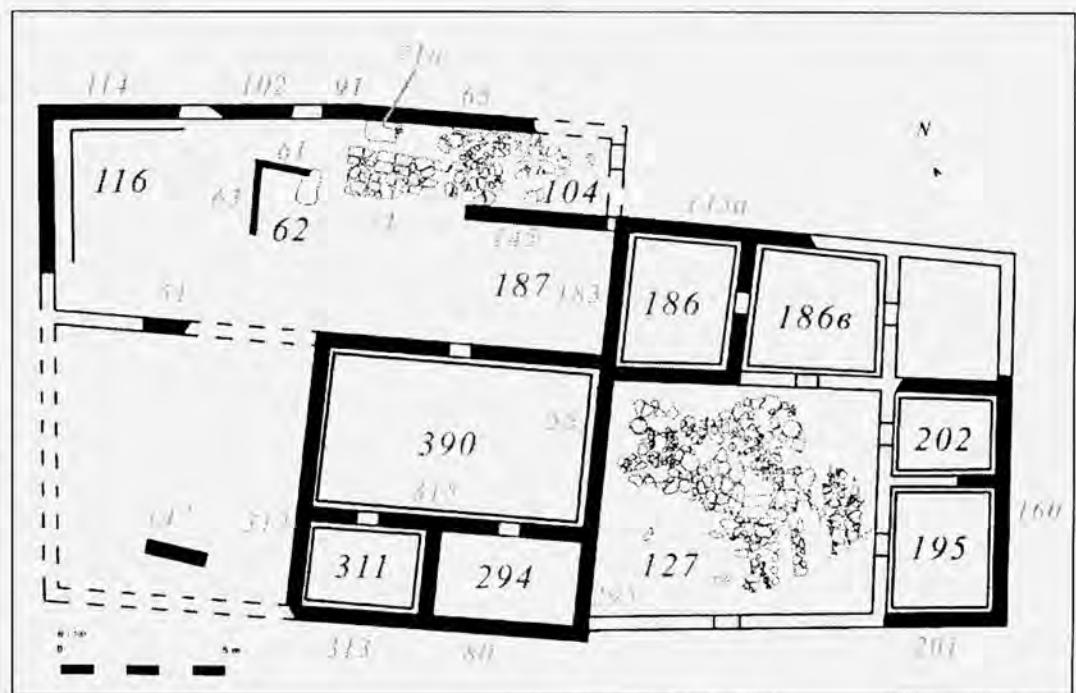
План домов II – 5.6. Реконструкция С.Д. Крыжицкого.
